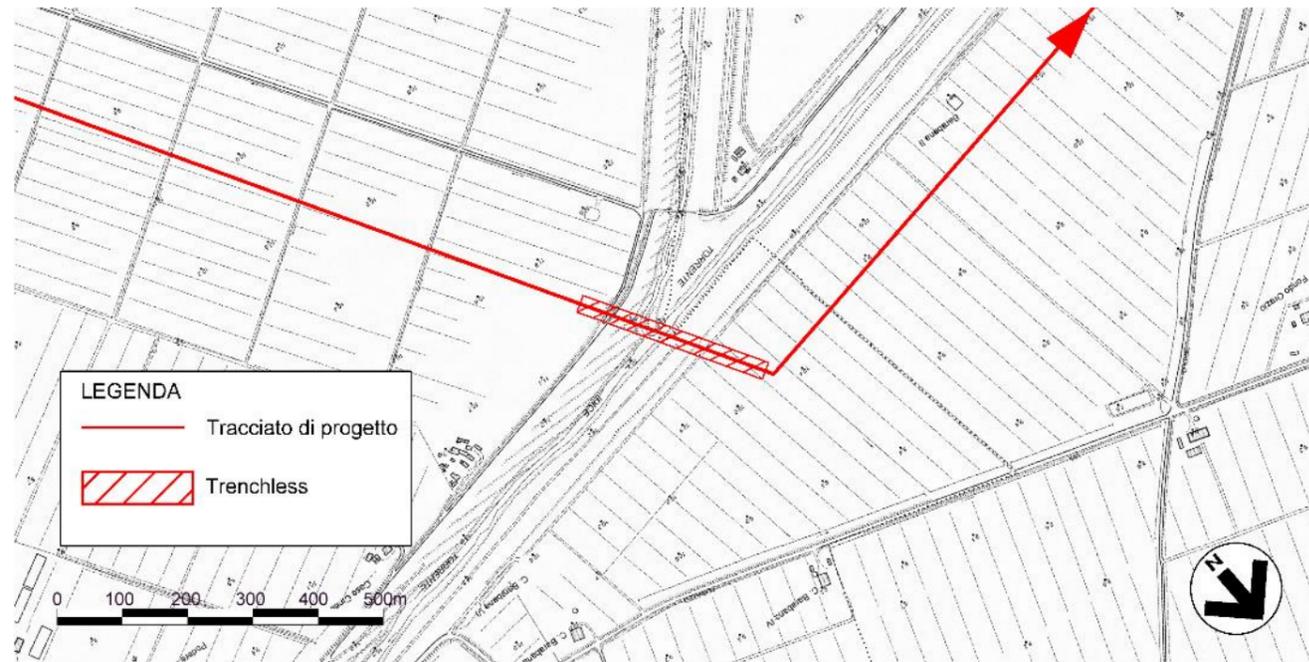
/CB: Attraversamento trenchless F. Sillaro
